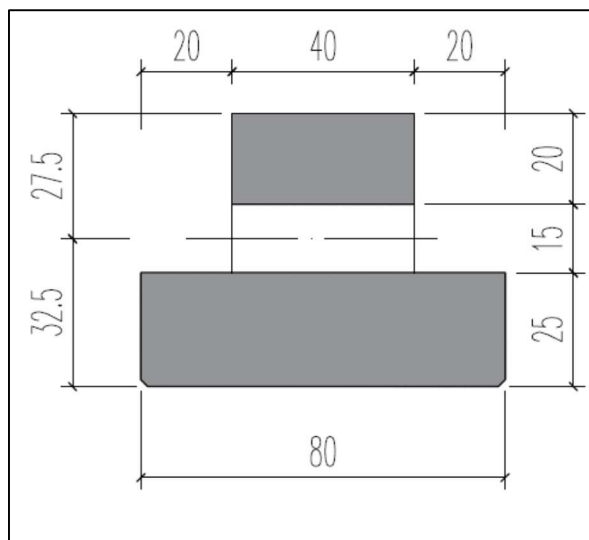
Sezione trasversale trave prefabbricata - sezione all'appoggio
